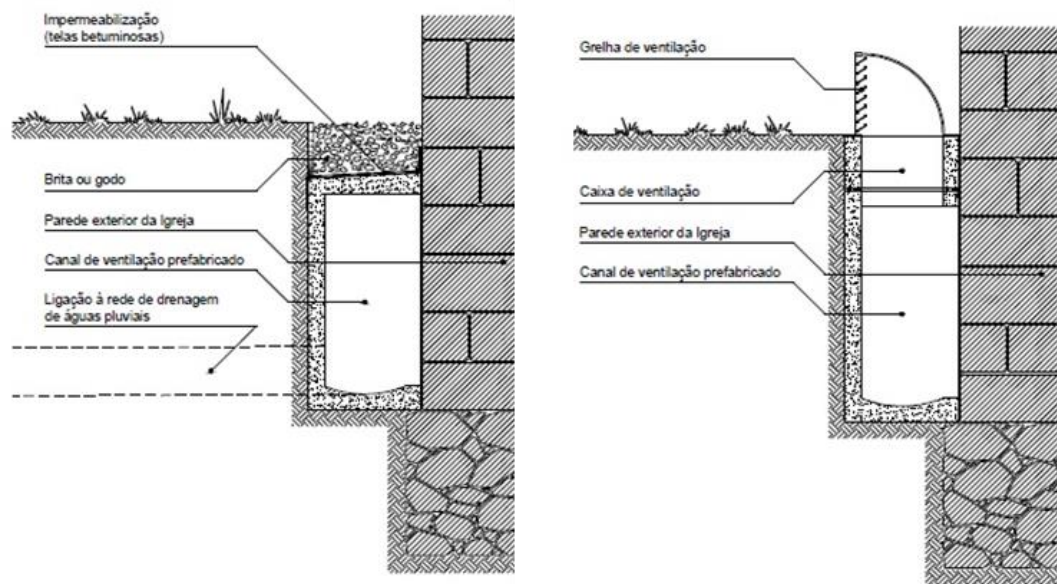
Cortes esquemáticos da ventilação da base das paredes exterior [3]
